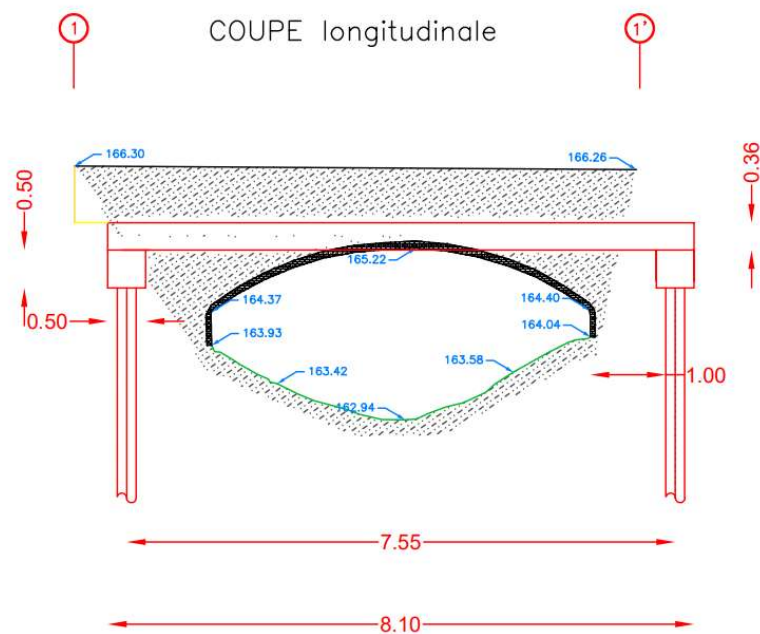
Coupe longitudinale du futur ouvrage extrait de [9]
